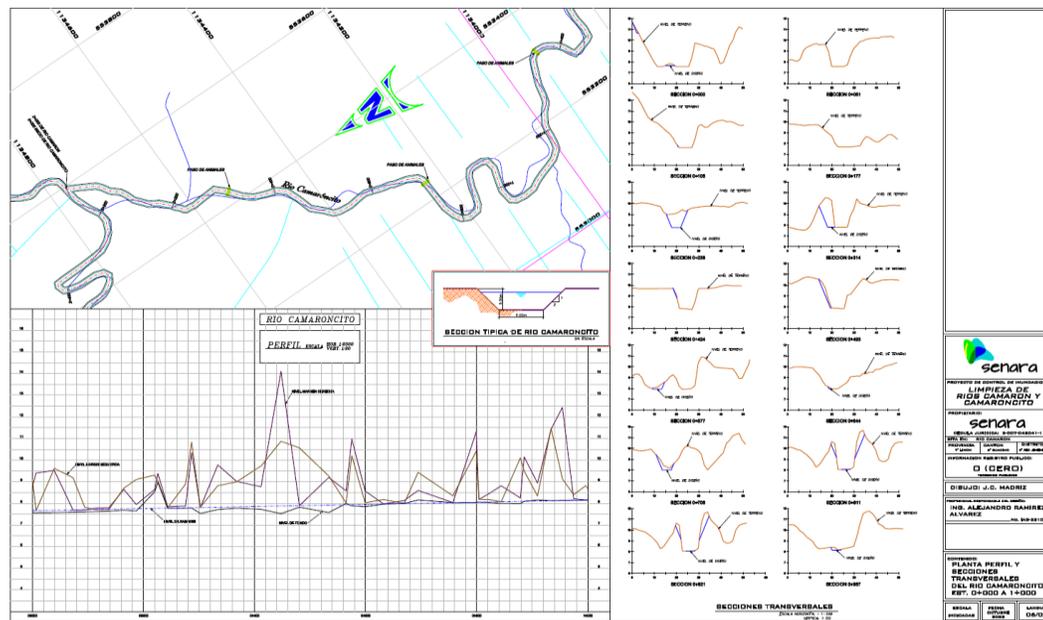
Vista en planta perfil y secciones transversales del Río Camaroncito.
